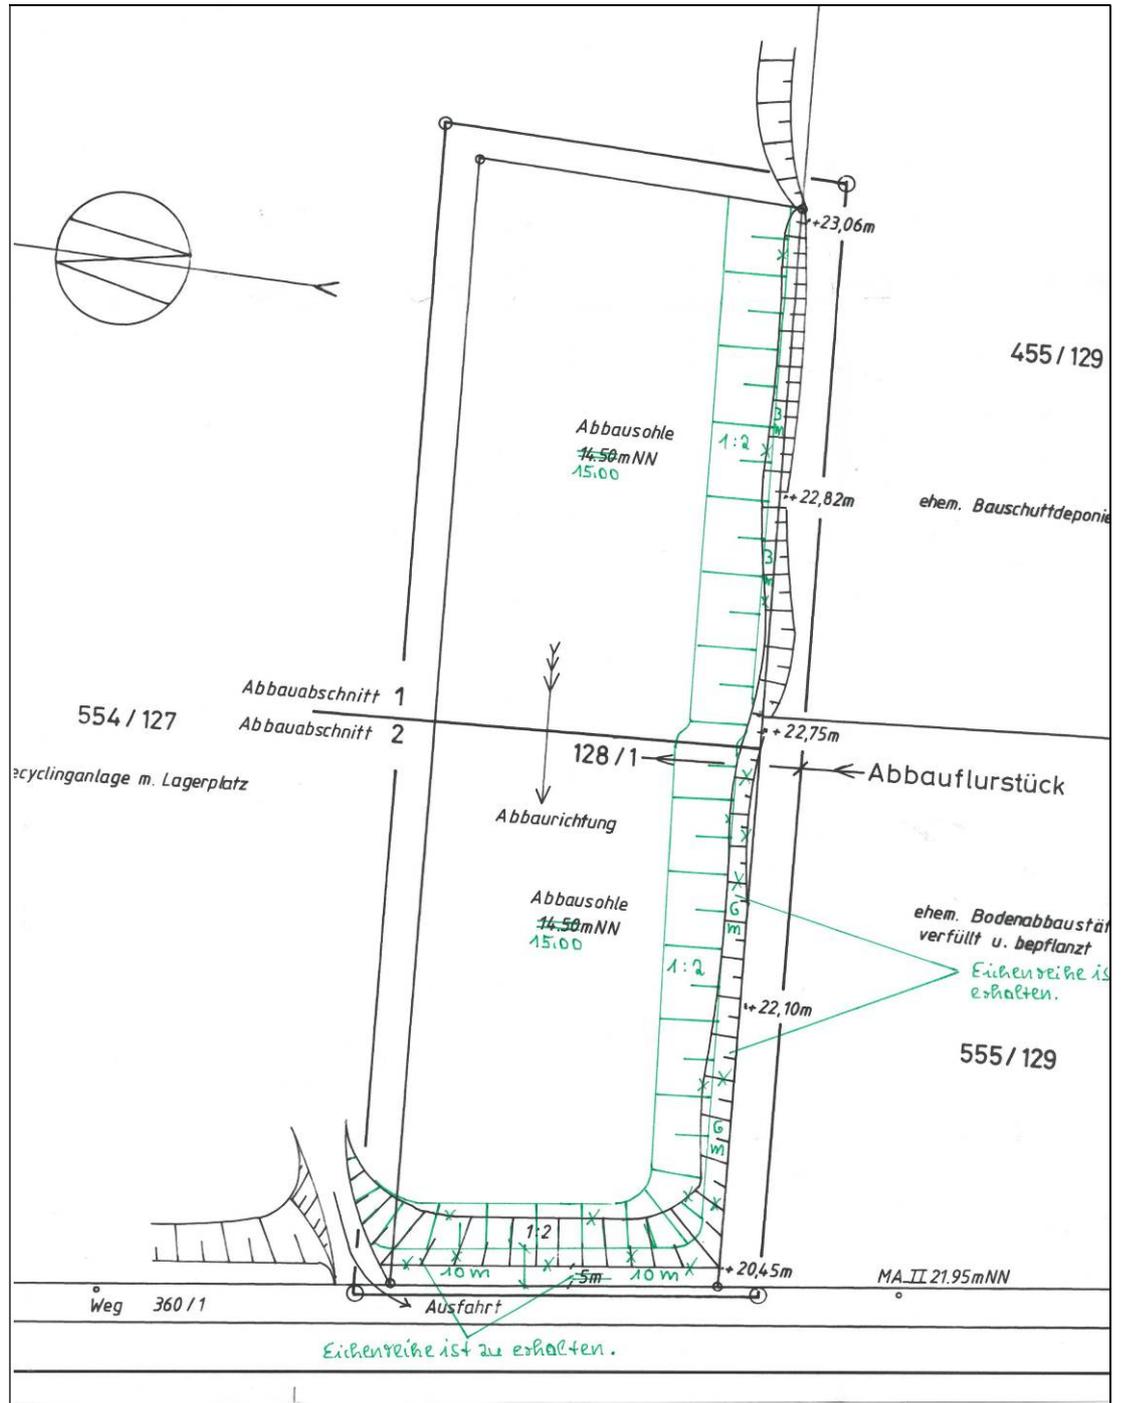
Abbauplan mit Darstellung der Abbauabschnitte (Kartengrundlage © LGLN)
